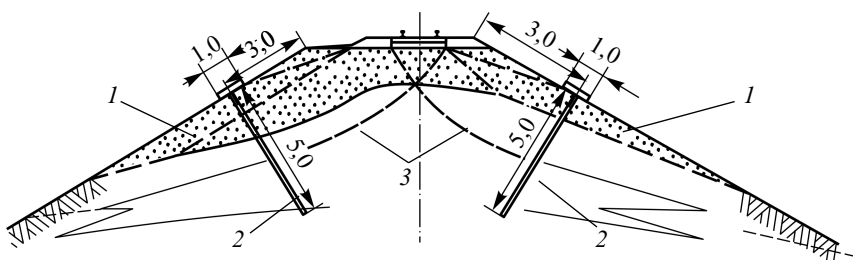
Усиление насыпи с неустойчивыми шлейфами анкерными конструкциями (размеры в м):
